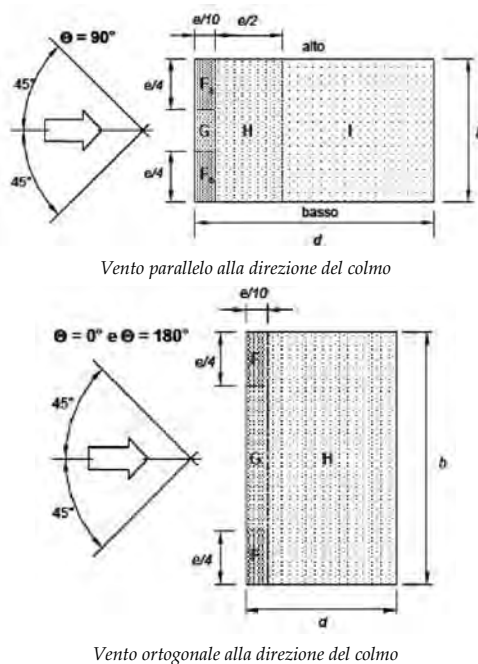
Suddivisione delle coperture a semplice falda in zone di uguale pressione
